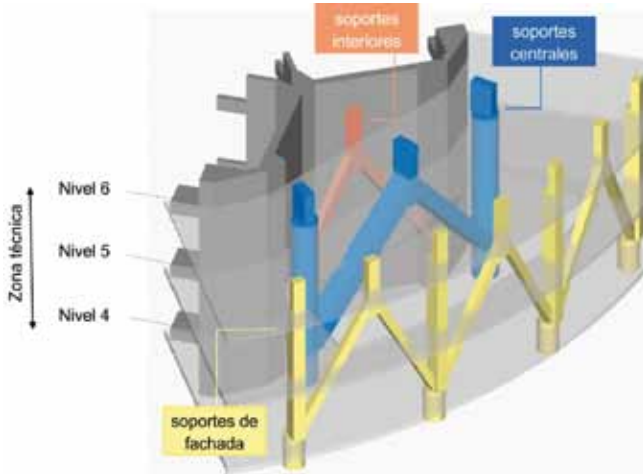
Disposición esquemática del apeo de soportes eliminados en planta 6ª
